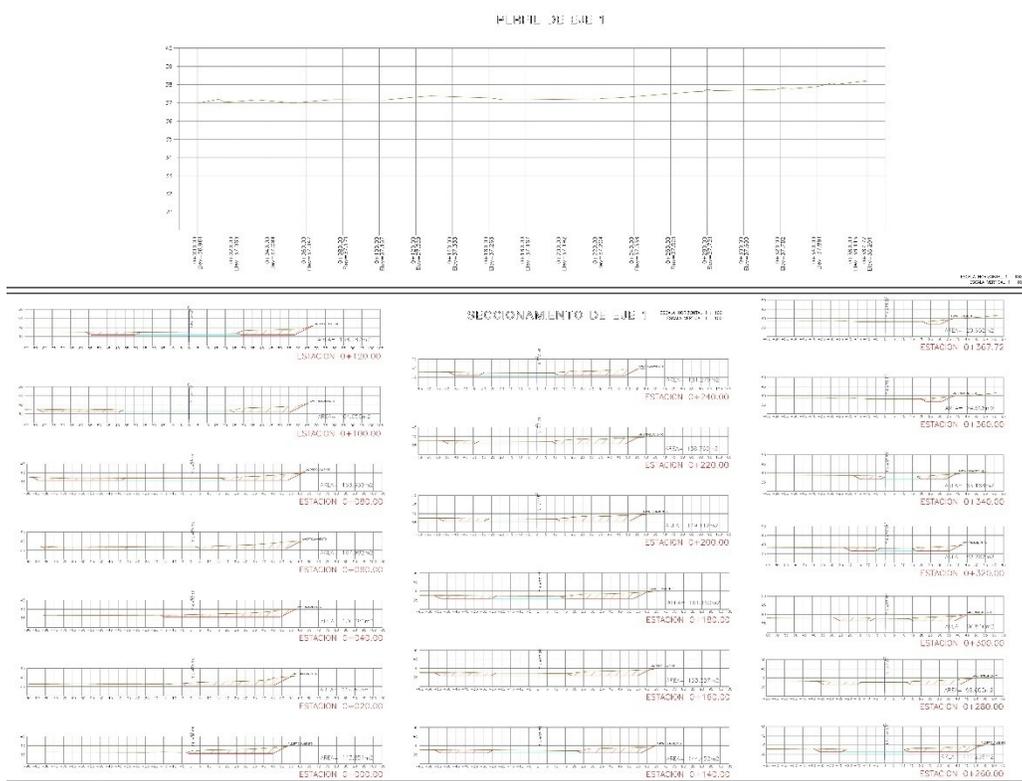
Perfil longitudinal y seccionamiento del eje 1
